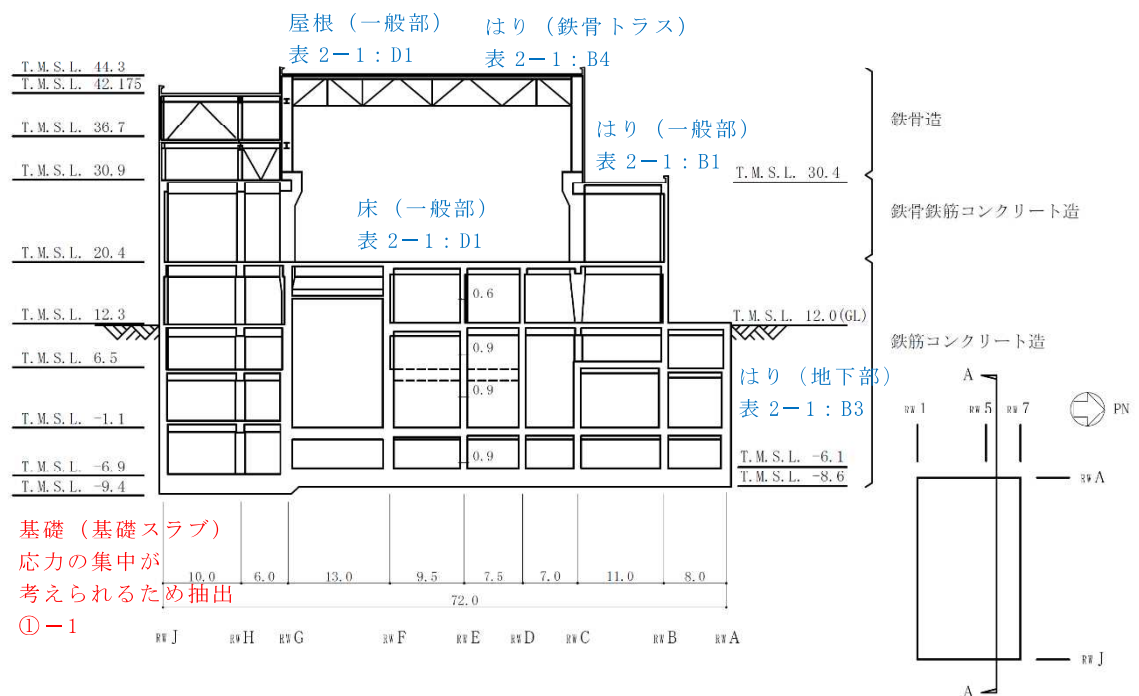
廃棄物処理建屋の概略断面図 (EW 方向) (2/2) (単位 : m)
